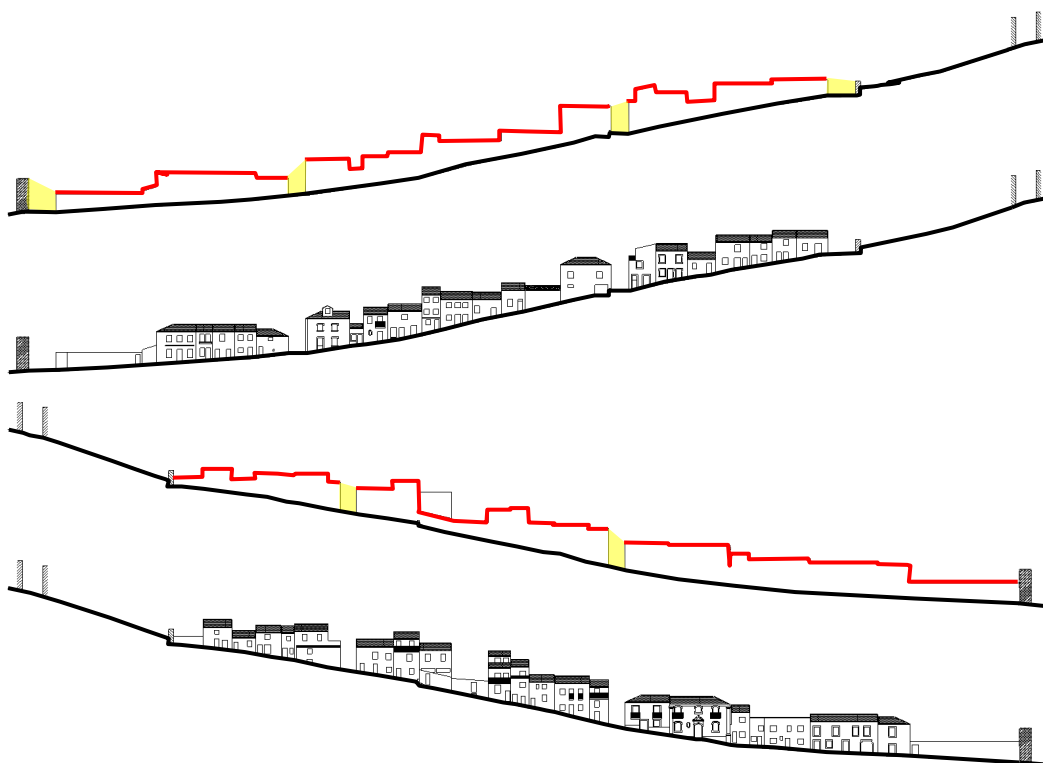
e 382, respectivamente - Perfis longitudinais da Rua do Muro em Castelo Branco.
